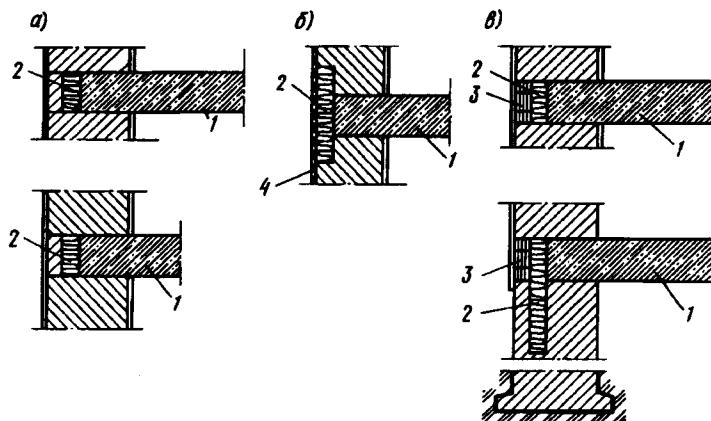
Утепление узла сопряжения железобетонной балки с наружной стеной
